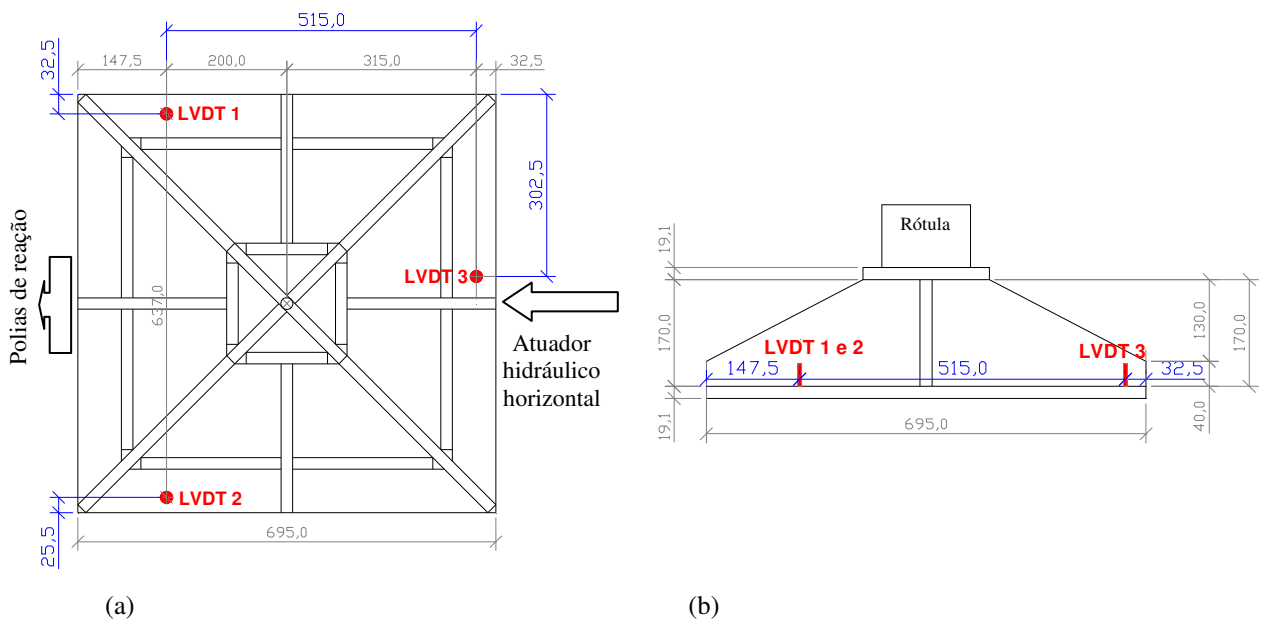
Locação dos transdutores de deslocamento (LVDT's): (a) planta esquemática; (b) seção esquemática
